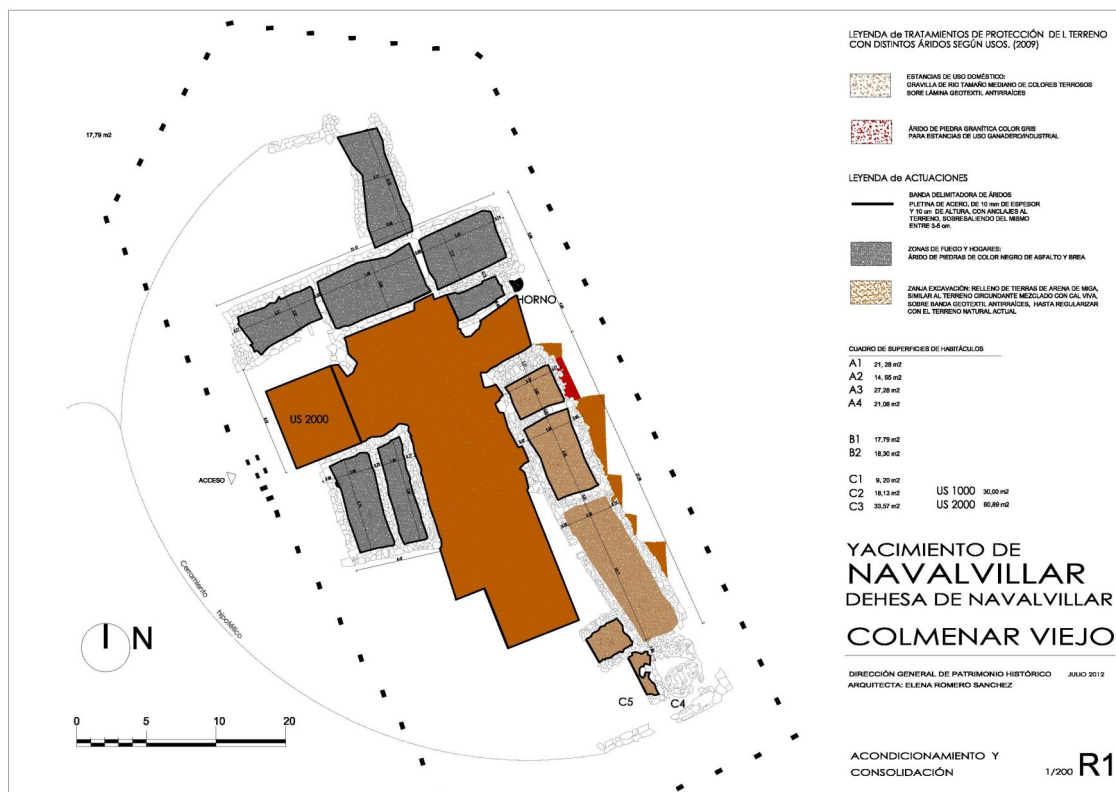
Plano de las áreas excavadas de Navalvillar.
